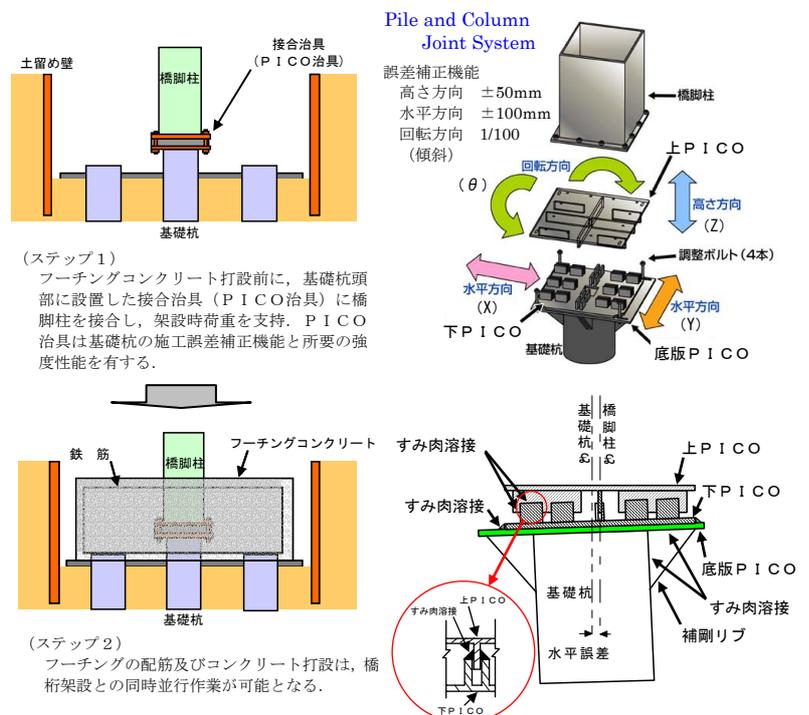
橋脚柱先行建て込み工法の概要 図-2 PICO治具構造と施工誤差補正の模式図
